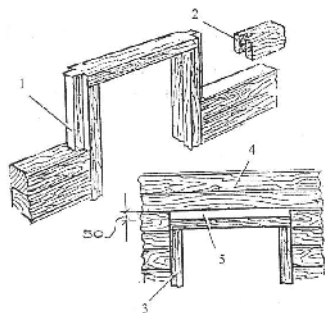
Установка дверной коробки: 1 - паз; 2 - шип; 3 - дверная коробка; 4 - брус; 5 - зазор
